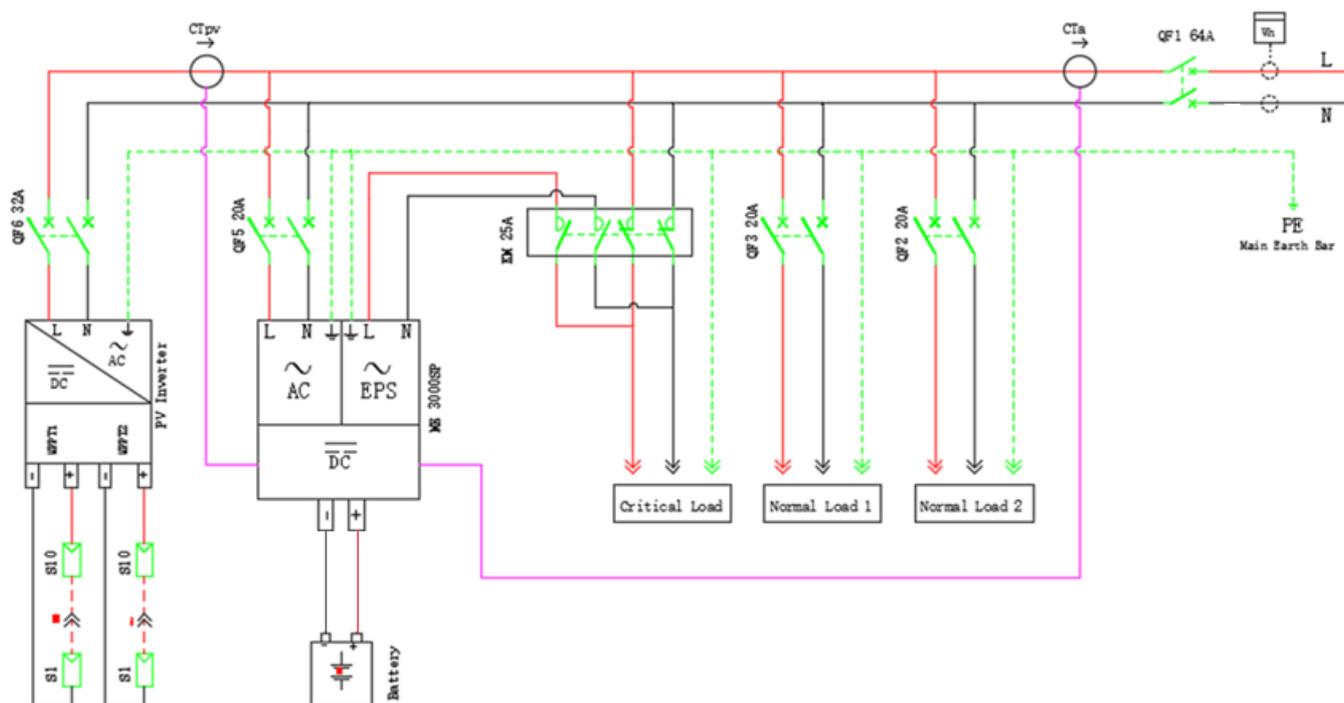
Esquema detallado de las conexiones en un equipo monofásico
